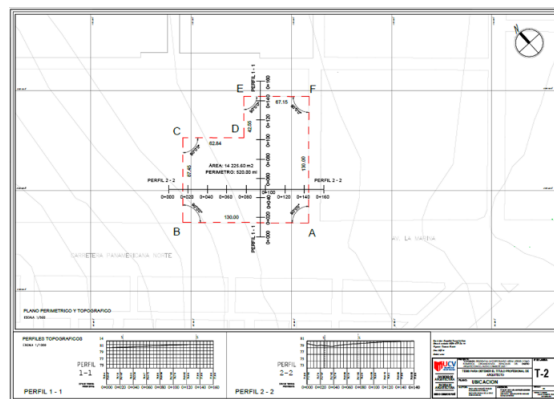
Plano topográfico del terreno. Fuente: Elaboración propia.
